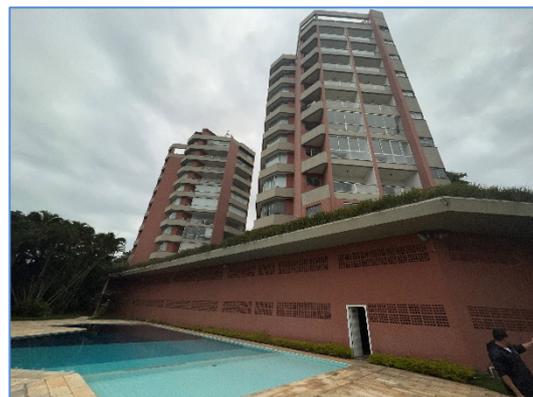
Vista da piscina da área comum e dois blocos de apartamento do Condomínio Santa Fé
